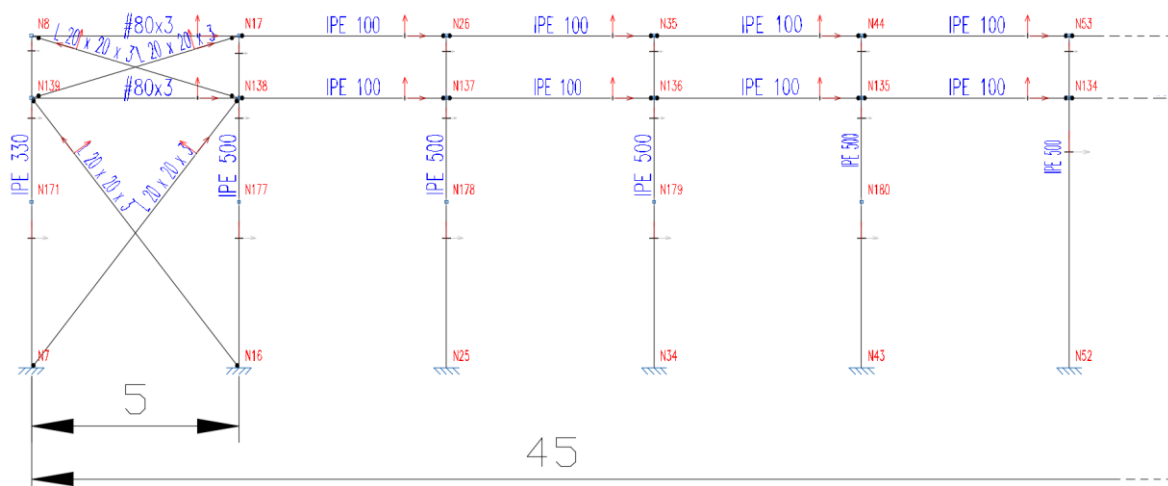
Parte de la fachada lateral de la nave secundaria con detalle de perfiles y nudos
